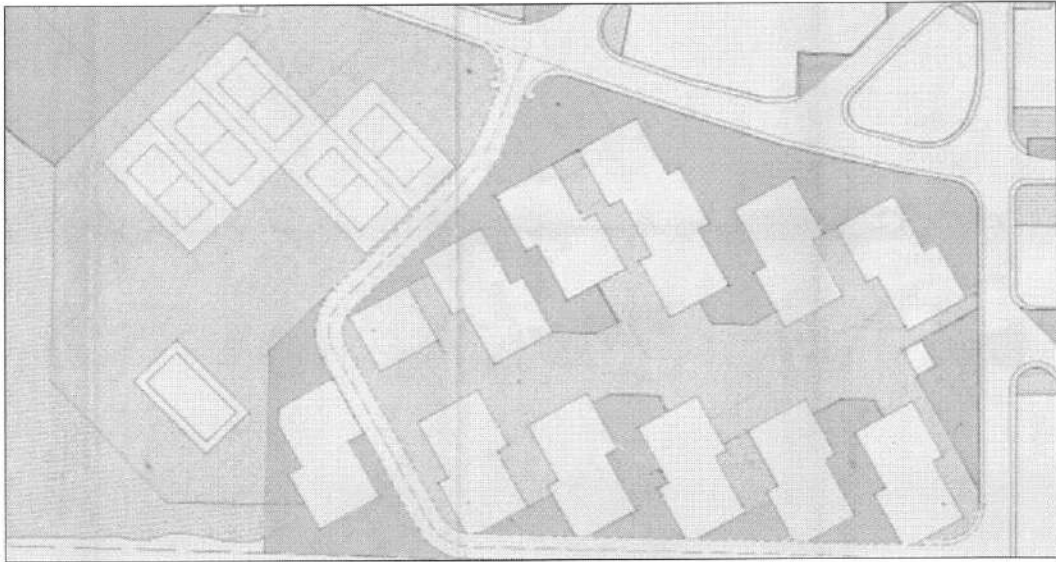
Stralcio piano di lottizzazione con individuazione dei lotti fondiari.
